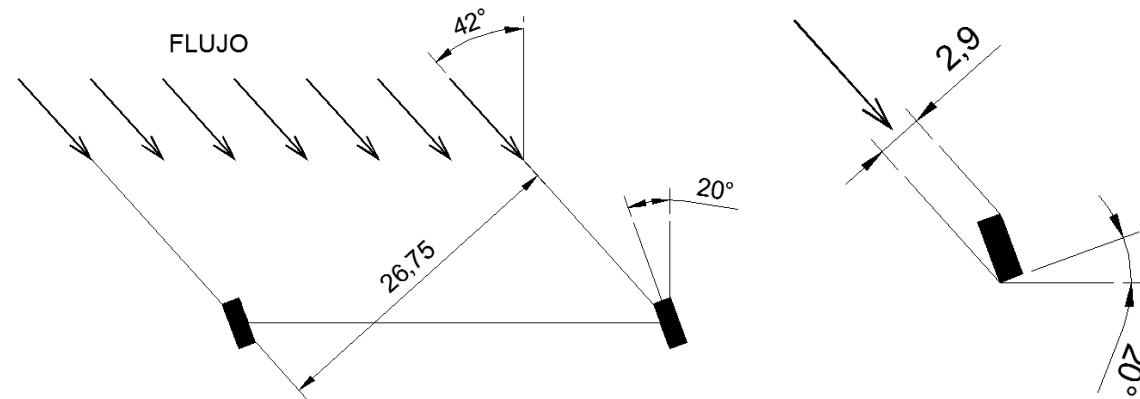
Orientación y separación de las pilas respecto al flujo (Fte.: AutoCAD)
